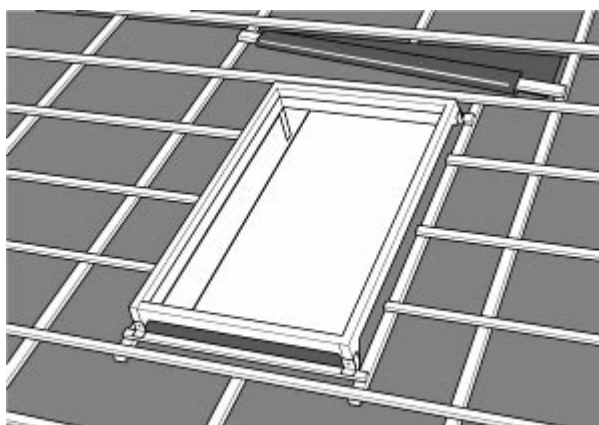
Pose sans ventilation de la sous-face – Fenêtre de toit et entourage de cheminée
